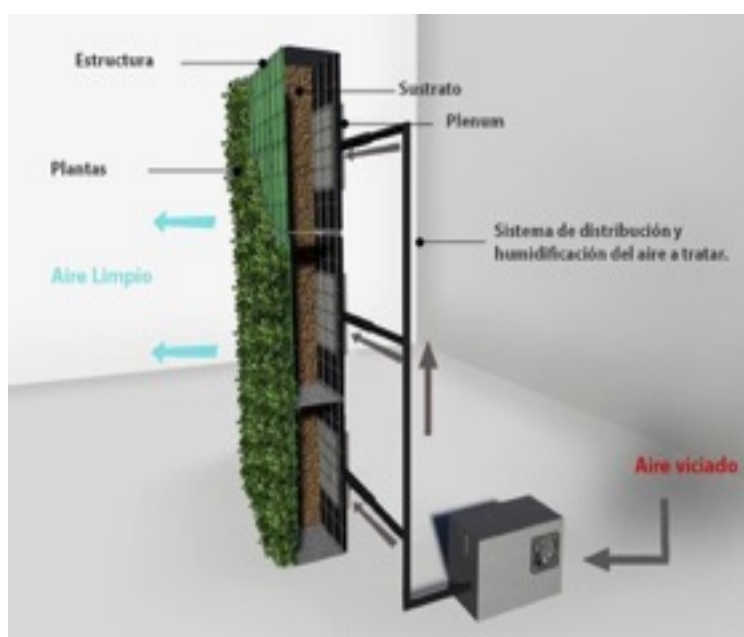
Estructura de un muro vertical descontaminante. Tomado de (Plataformaarquitectura, 2016)
